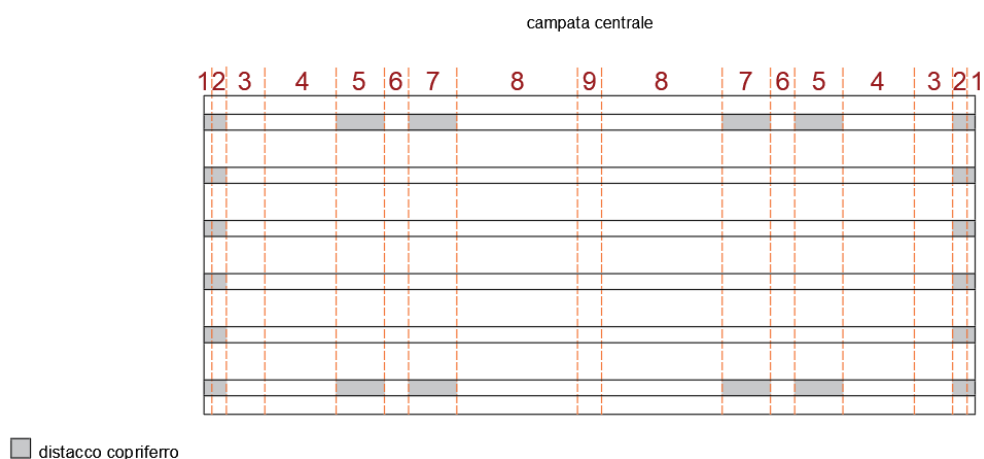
Ponte sul torrente Mavigliano, Caso I_ev1 schema deterioramento in pianta
